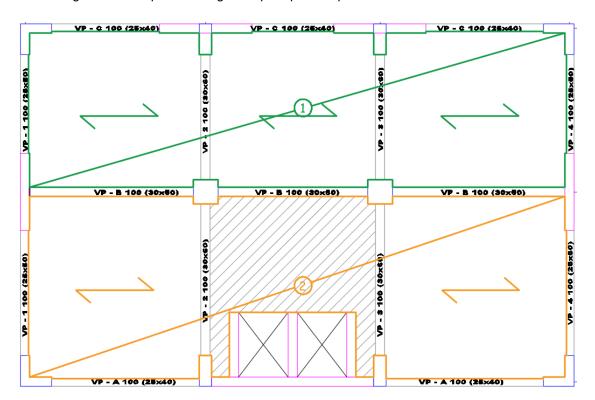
Croquis de la vigueta tipo 1 planta típica.
